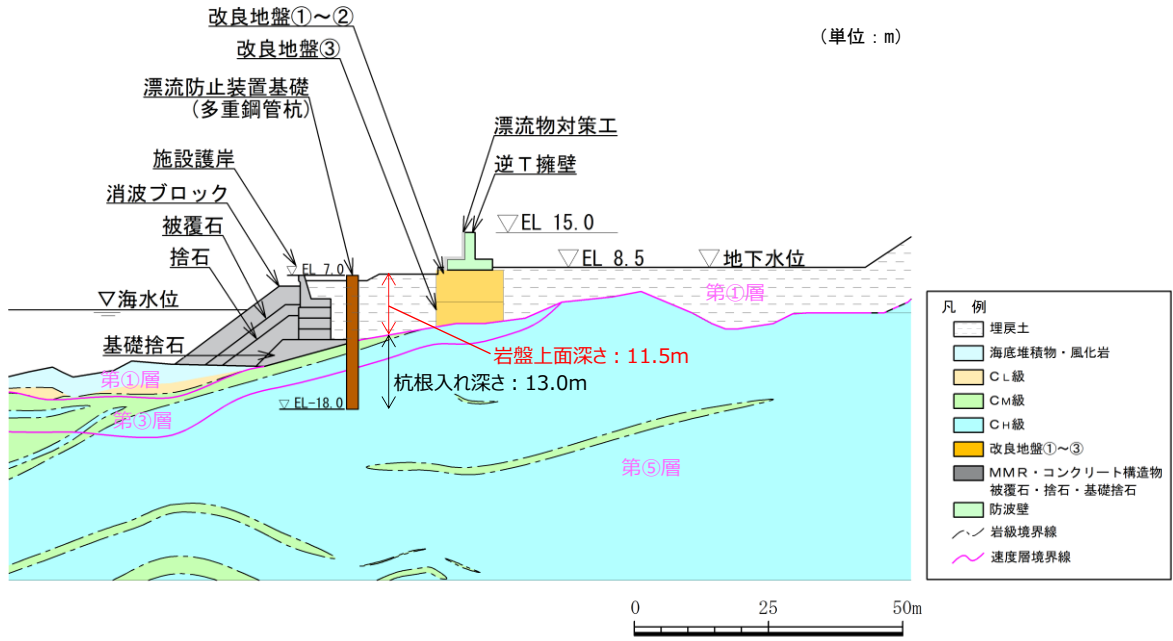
漂流防止装置基礎（多重鋼管杭）の横断面図（①-①断面）
